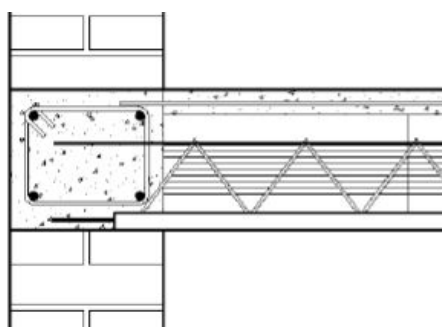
Sezione Solaio – cordolo con travetti prefabbricati
